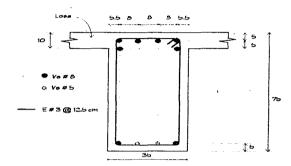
Armado propuesto para la viga B28 del nivel 2 del eje 2, edificio diseñiado en la zona !!
